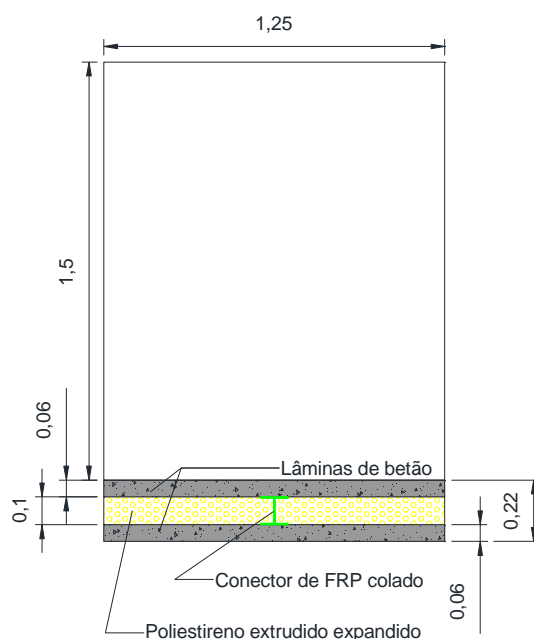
Geometria do painel sandwich com conectores perfil I colados de FRP e espessura da camada de betão de 60 mm (vista em planta, unidades em metros).
